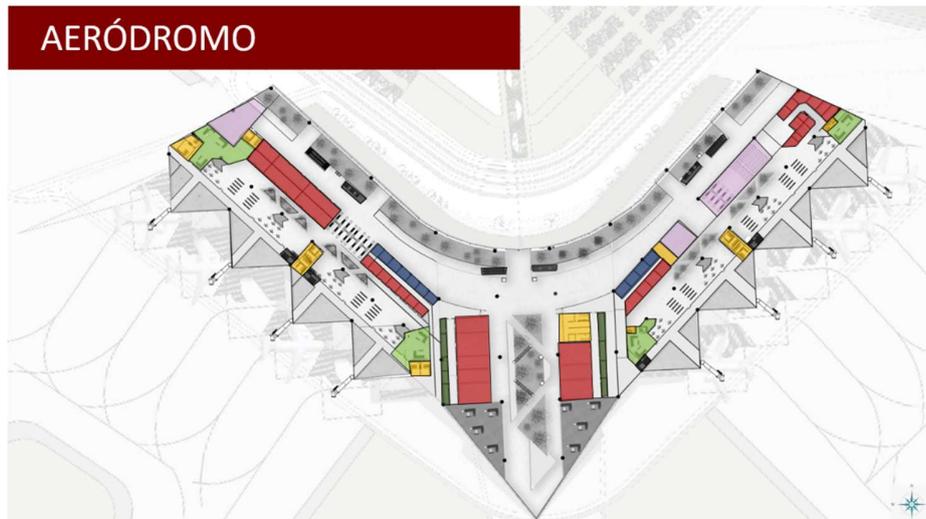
Plano de zonificación 2 piso. Fuente: Autores
